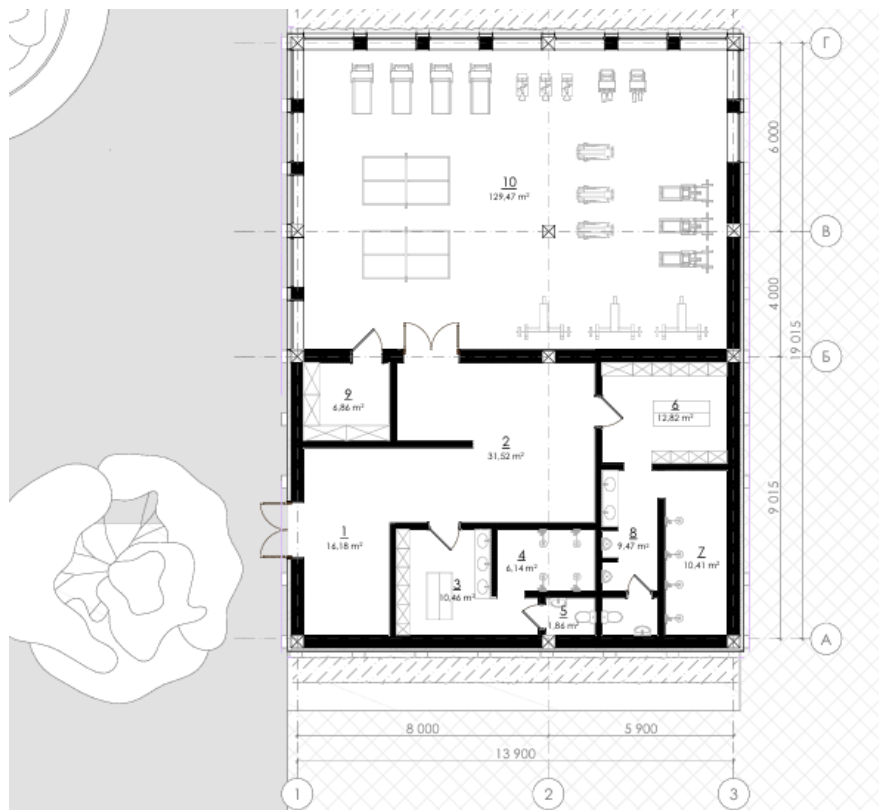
Планувальні рішення 1 поверху спортзалу
